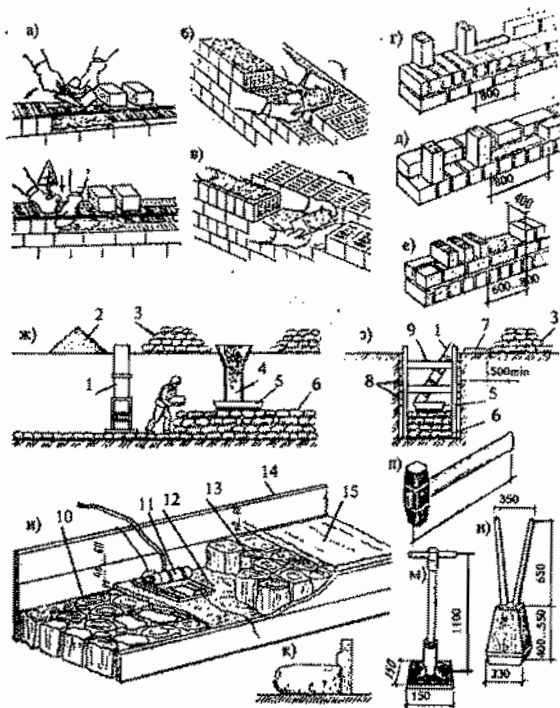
Кладка из керамических, бетонных и природных камней: а - укладка наружной тычковой версты; б - укладка забутки; в - укладка керамических камней внутренней версты; г, д, е - основные приемы укладки бетонных камней; ж, з - организация бутовой кладки; и - бутровая кладка "под лопатку"; к - то же, "под скобу"; л, м, н - используемые инструменты (л - молоток-кулачок; м, н - металлическая и деревянная трамбовки); 1 - желоб; 2 - щебень; 3 - бутový камень; 4 - лоток; 5 - ящик для раствора; 6 - кладка; 7 - настил; 8 - крепление стенок траншеи; 9 - распорки; 10 - первый слой камня; 11 - площадочный вибратор; 12, 15 - раствор; 13 - второй слой камня; 14 - опалубка
